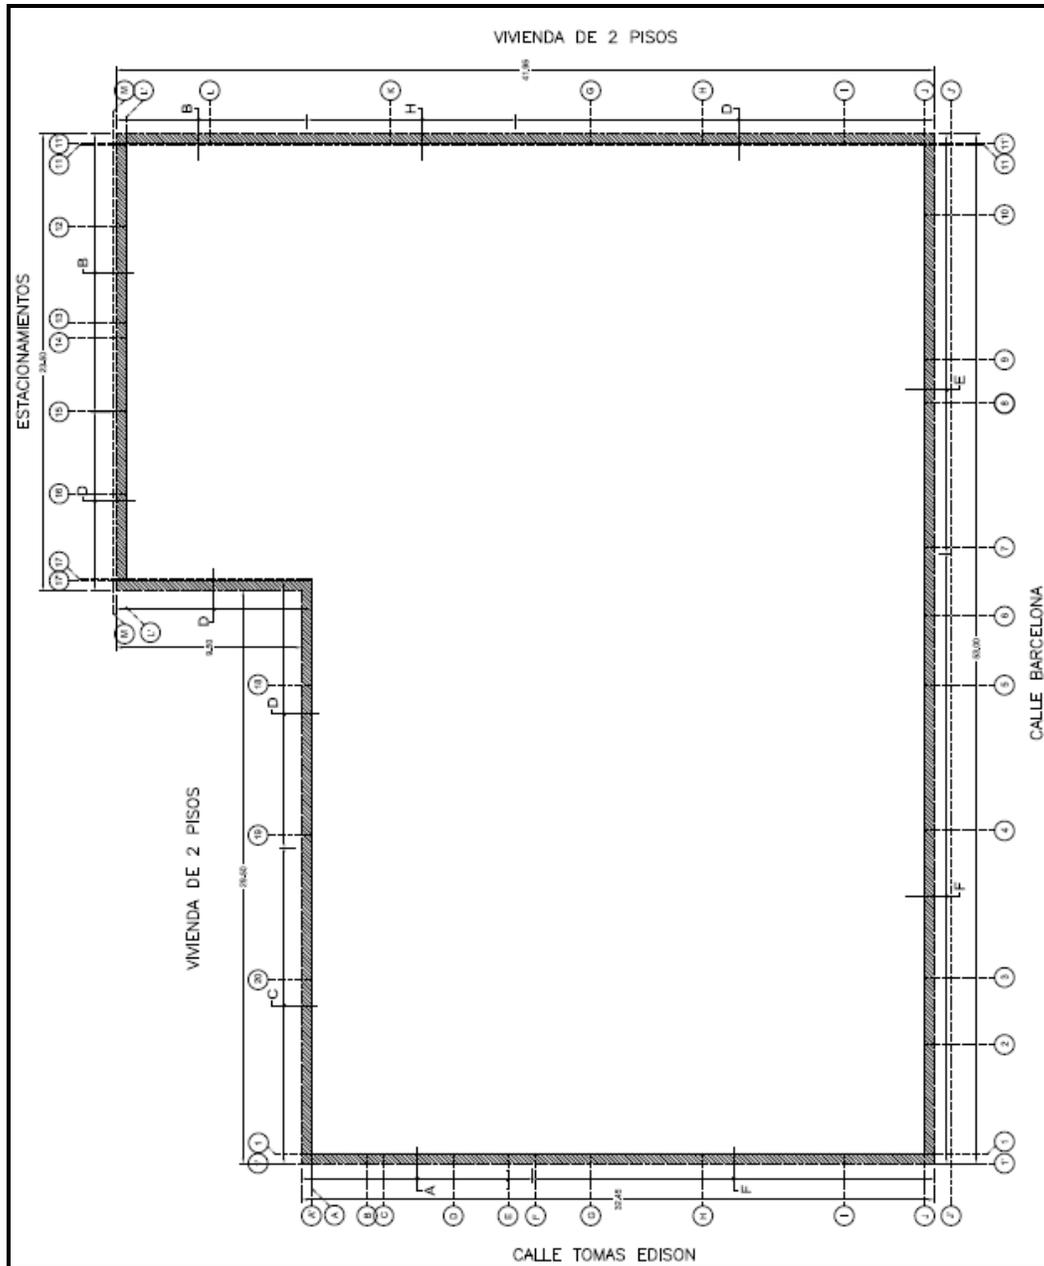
Plano en planta obra 1 – Edificio Barcelona
